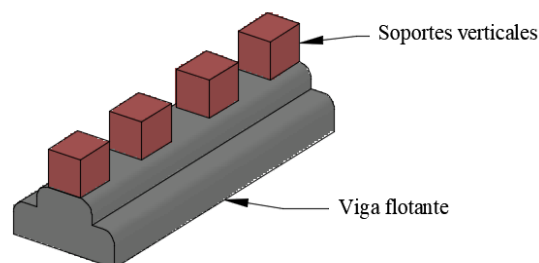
Ejemplo de vigas flotantes de cimentación.
